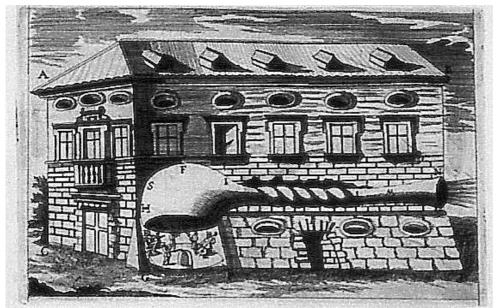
Conduits architecturaux [Kircher, 1673, p. 143]
